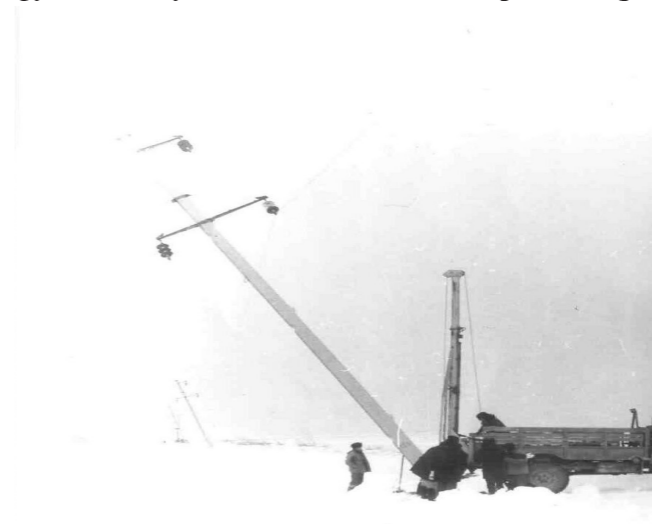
Нарушение устойчивости свободстоящей железобетонной опоры ЛЭП
